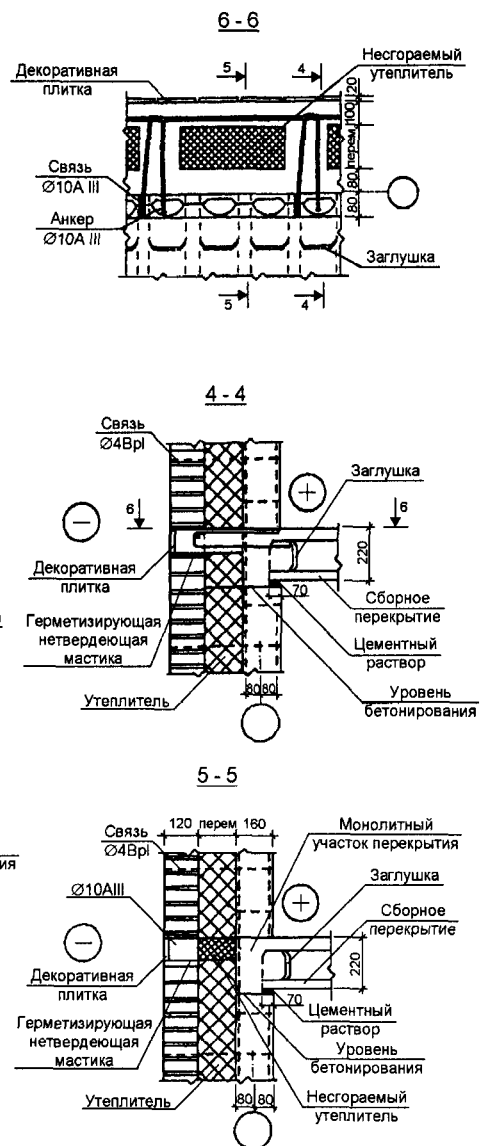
Монолитная слоистая наружная стена с облицовкой кирпичом
